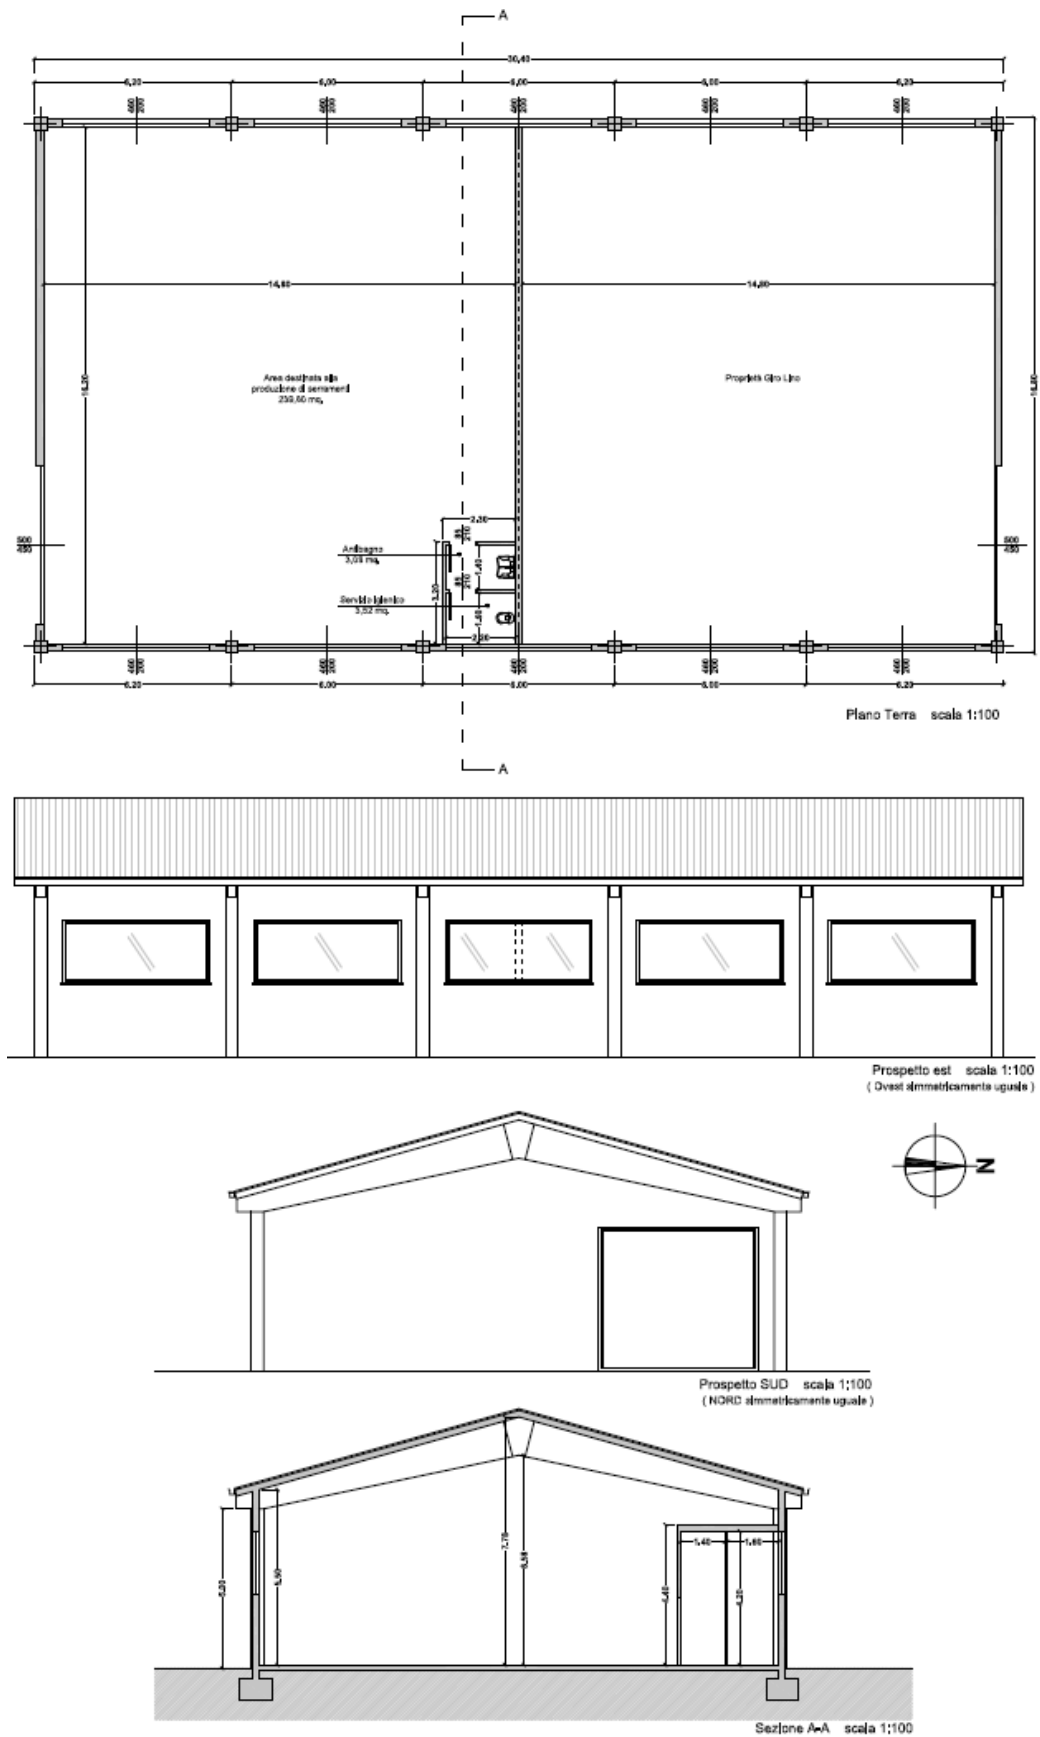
Stato di progetto: planimetria prospetti e sezione - estratto della Tav.3di progetto
